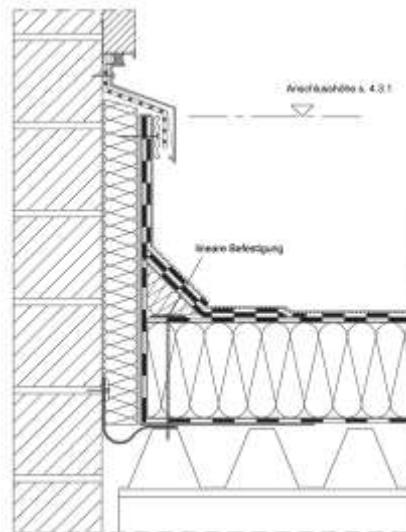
Beispiel für wärmegedämmtes, nicht belüftetes Dach mit Abdichtung auf Trapezblech, Anschluss an aufgehende Wand
